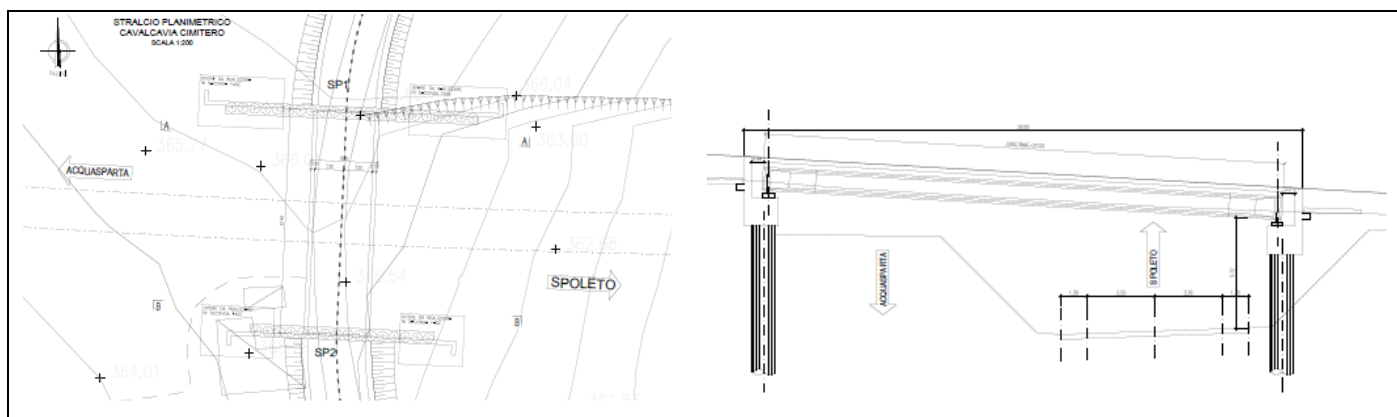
Stralcio planimetrico e Sezione Longitudinale del Cavalcavia Cimitero.
